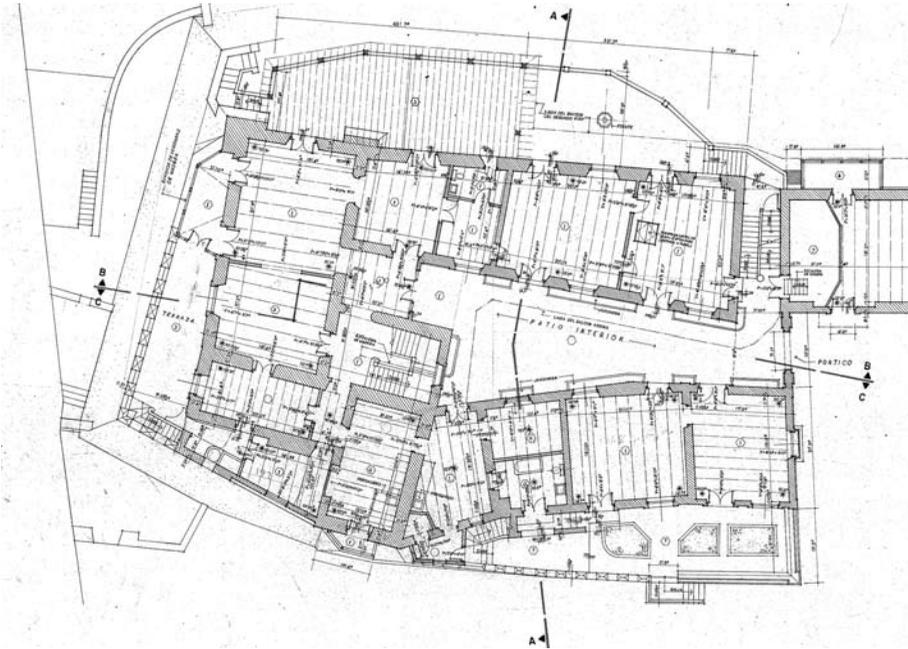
Detalle del edificio del museo en los planos de Casa Blanca de 1967.
